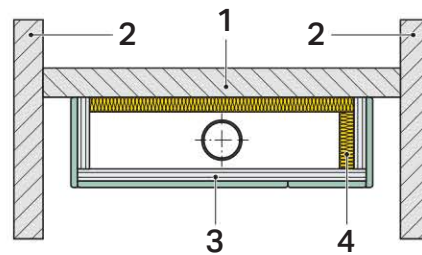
Grundriss, Leitungen in Schacht verlegt
